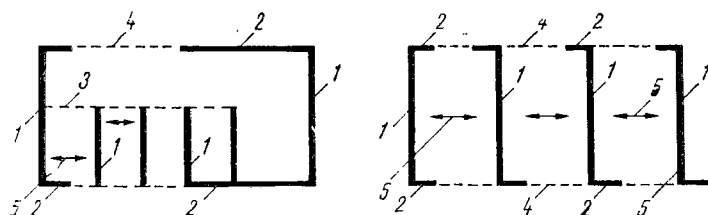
Structuri cu ziduri portante transversale, rigidizate longitudinal prin porțiuni de pereți exteriori, de contravîntuire;
